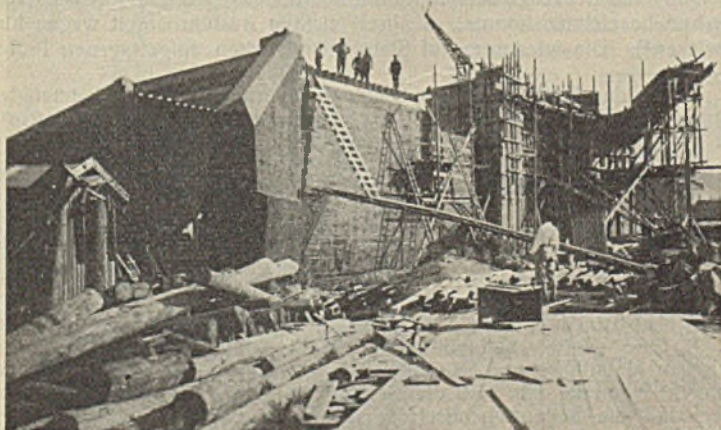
Bauteil unter der Staatsstraße (im Vordergrund) von Nordwesten gesehen.
